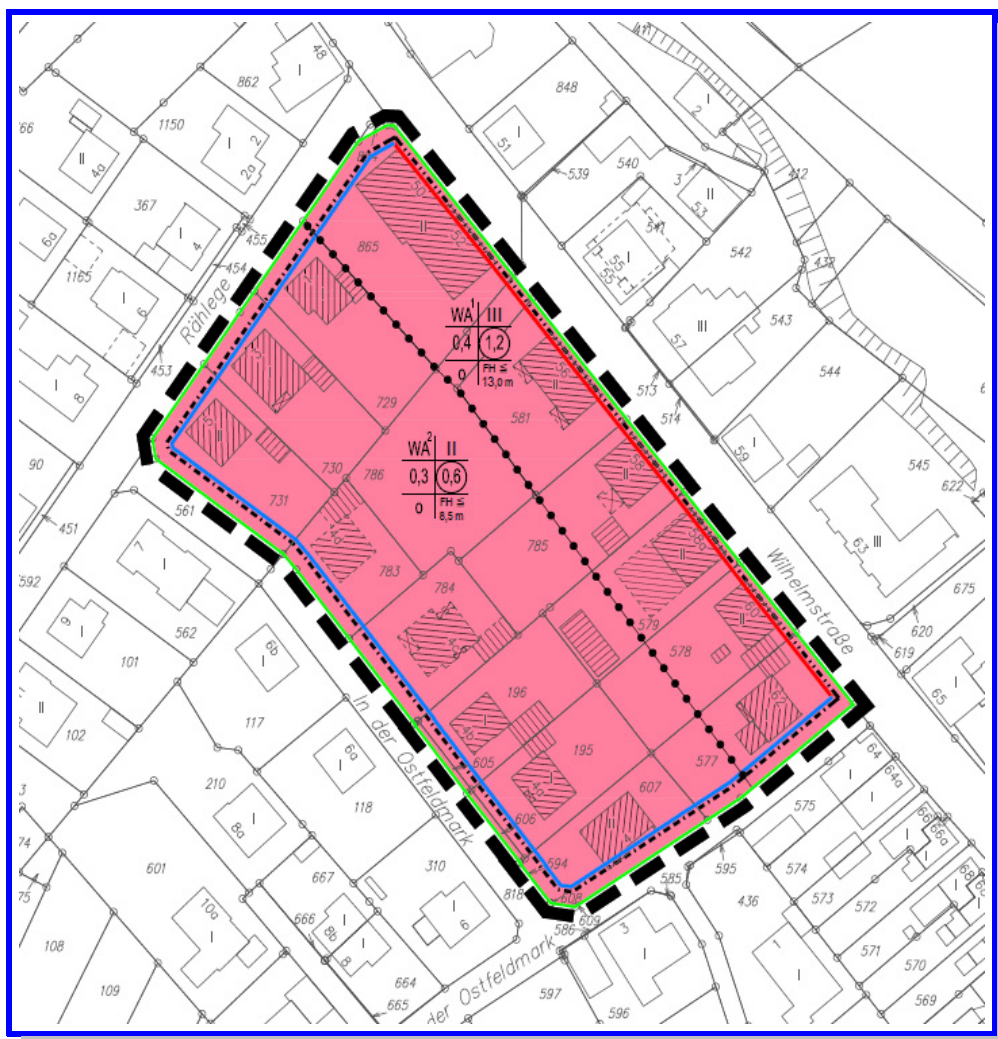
Entwurf des Bebauungsplans Nr. 147 (STADT IBBENBÜREN 2021)
